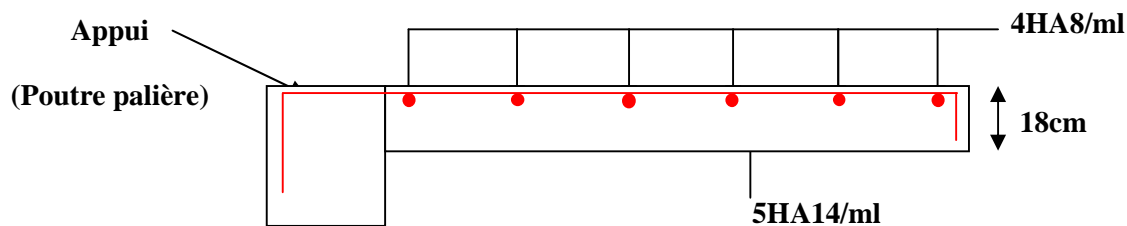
schéma de ferrailage du palier en consol de l'escalier RDC
